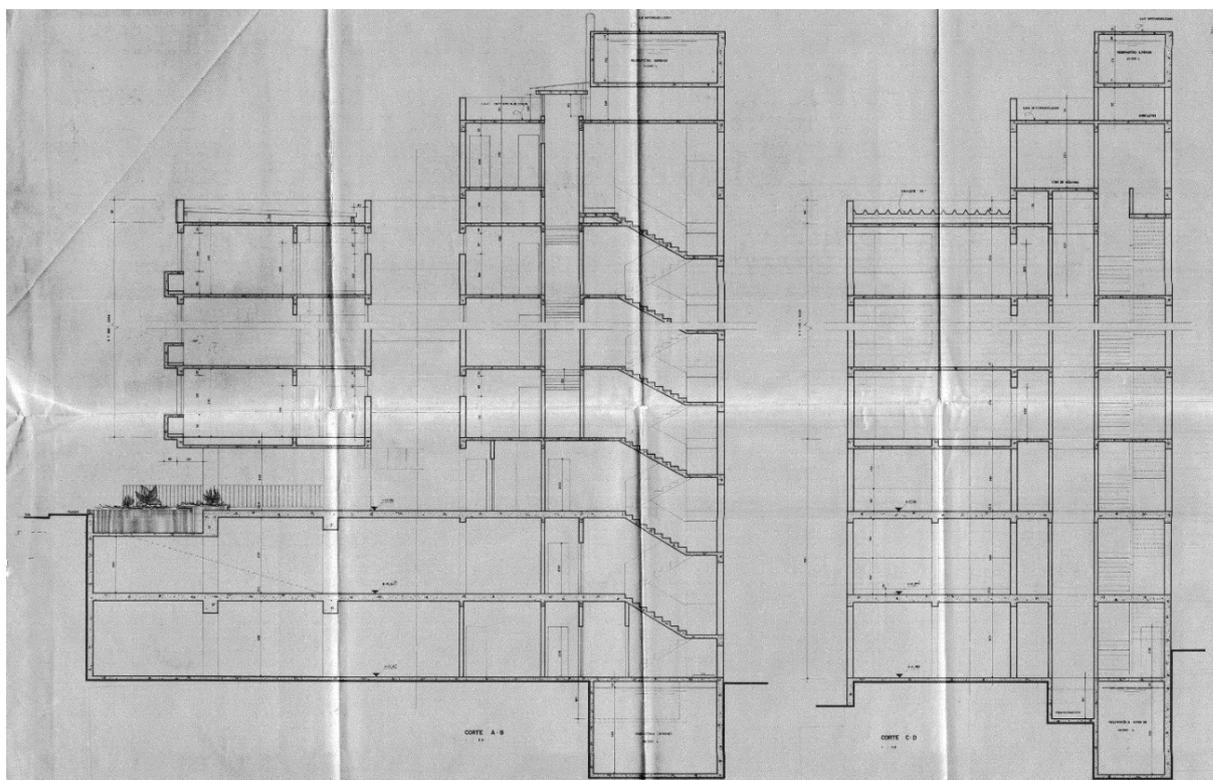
Corte A-B, no sentido longitudinal, e Corte C-D, no sentido transversal, destacando-se a estrutura reforçada nos pavimentos semienterrados e os elementos sob esquadrias projetados externamente.
